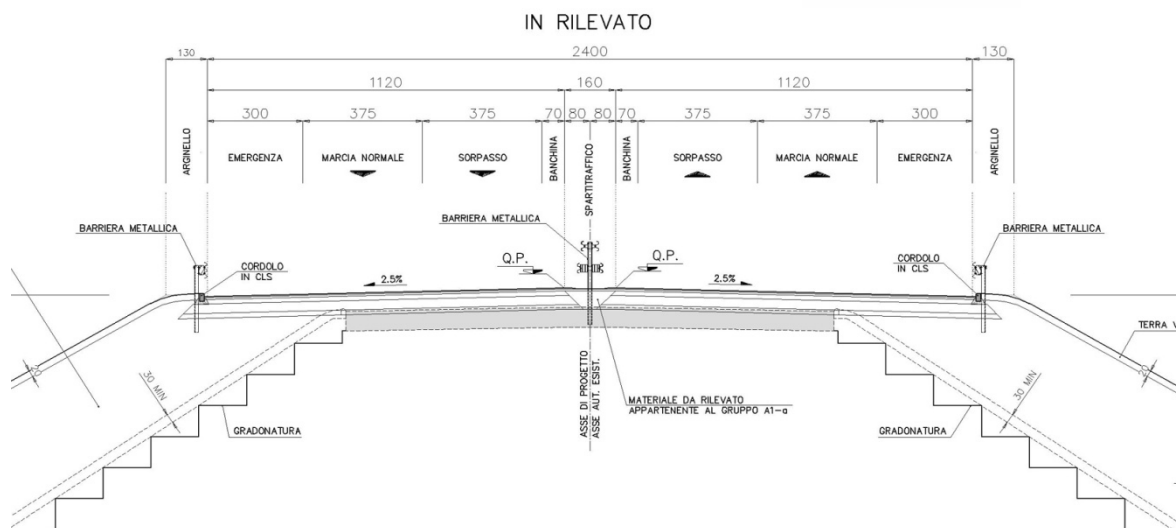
Sezione tipo di progetto (adeguamento SS1 Aurelia)
